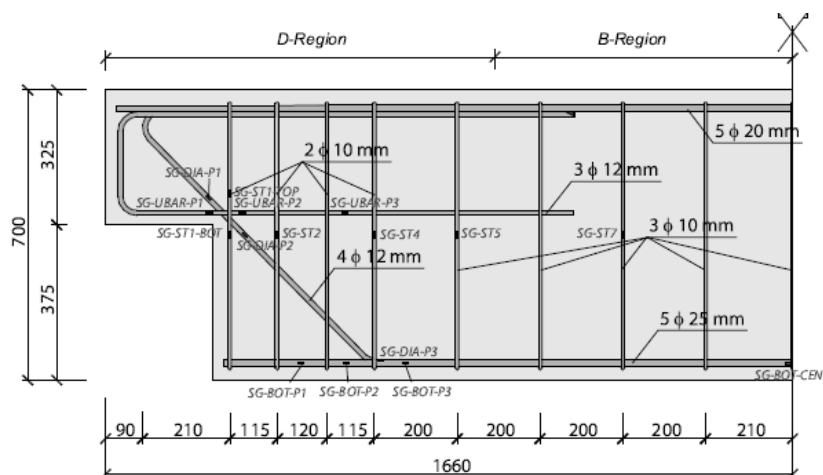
Geometria della sella e disposizione delle armature nel campione NS_REF [3]
